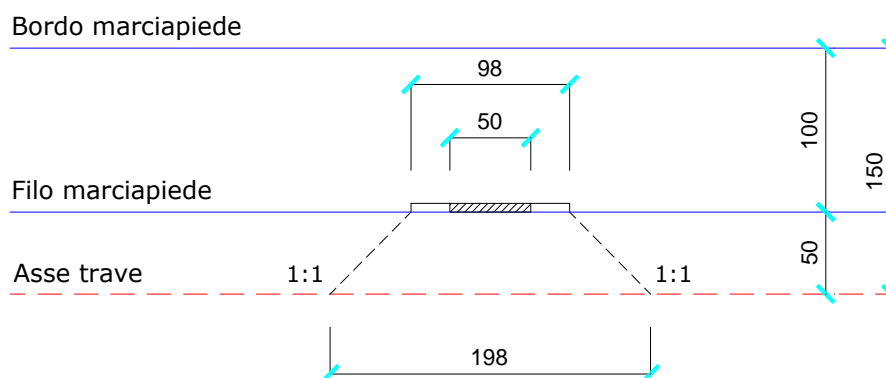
Diffusione nel piano orizzontale del carico svio zona tipica
